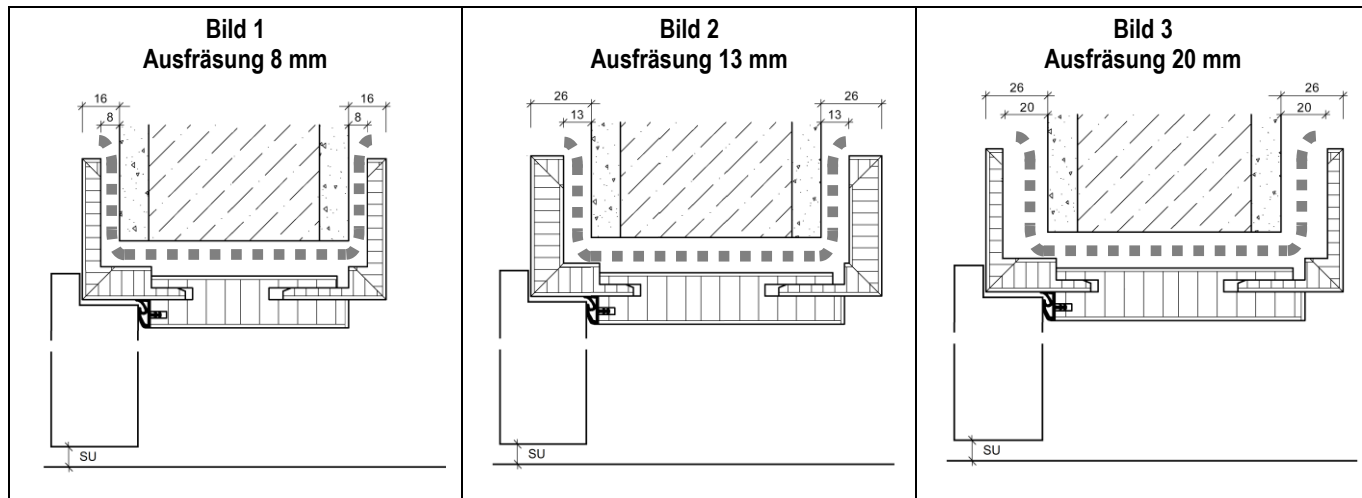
Ausfräsung 8 mm 	Bild 2 Ausfräsung 13 mm 	Bild 3 Ausfräsung 20 mm
